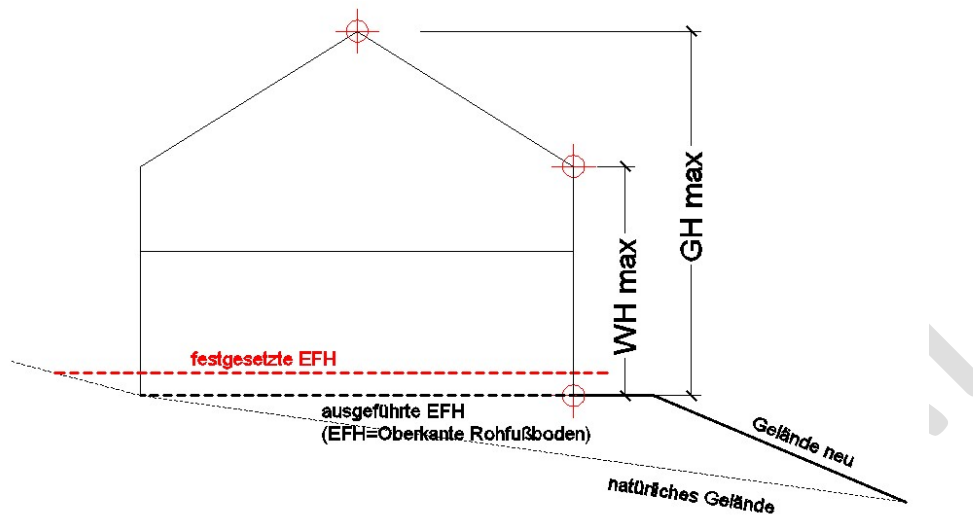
Erläuterungsskizze, zweiseitig geneigtes Dach (Satteldach und Walmdach)
